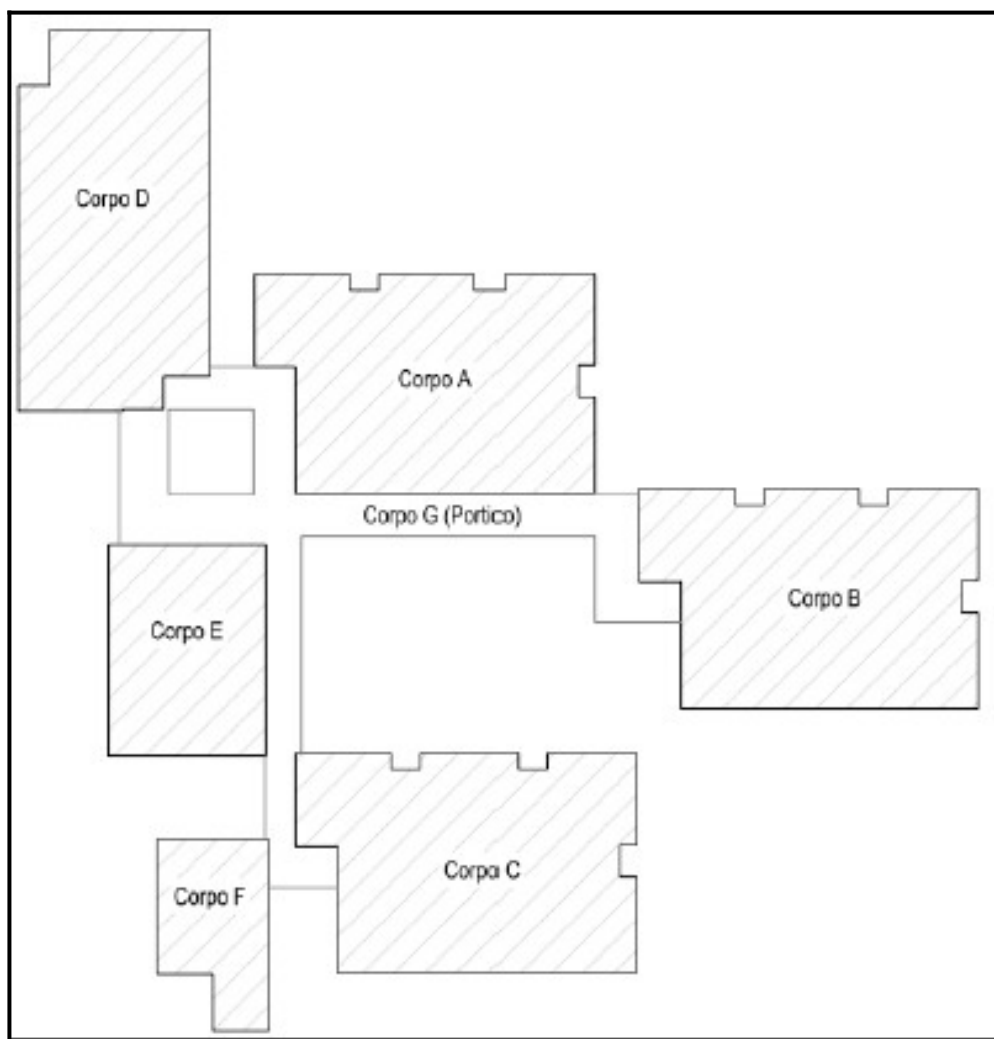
schema planimetrico con identificazione dei corpi strutturali
